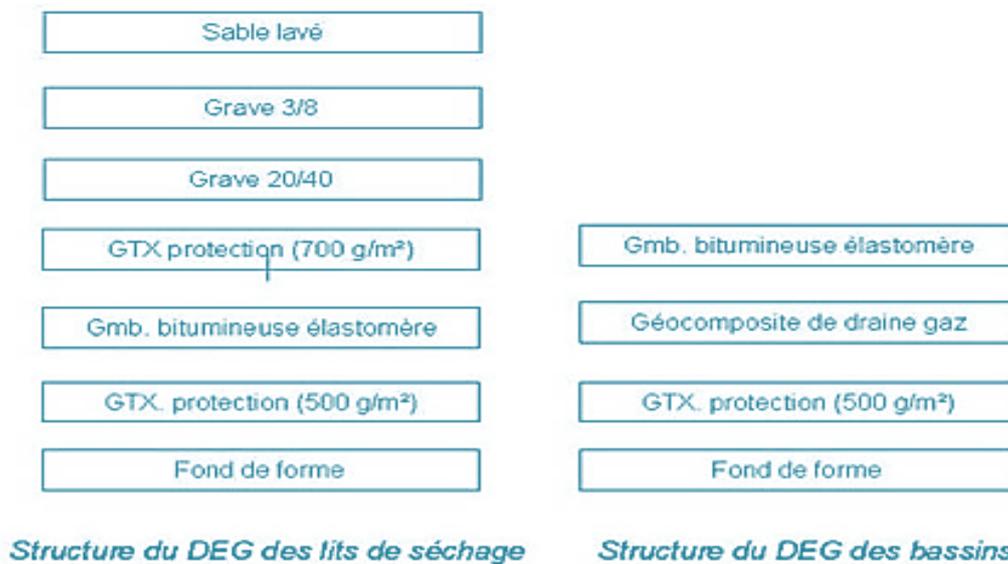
Structure des Dispositif d'Étanchéité et de Drainage par Géosynthétique
